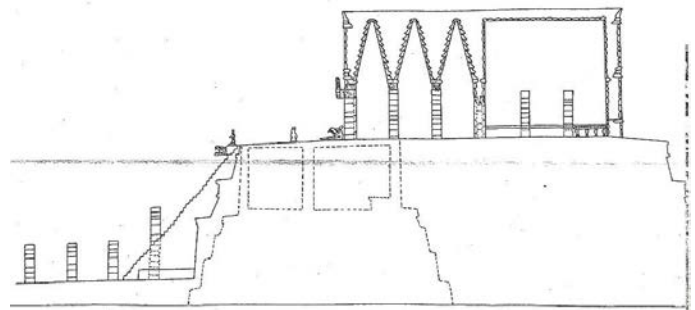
Corte del Templo de los Guerreros que muestra la Subestructura
